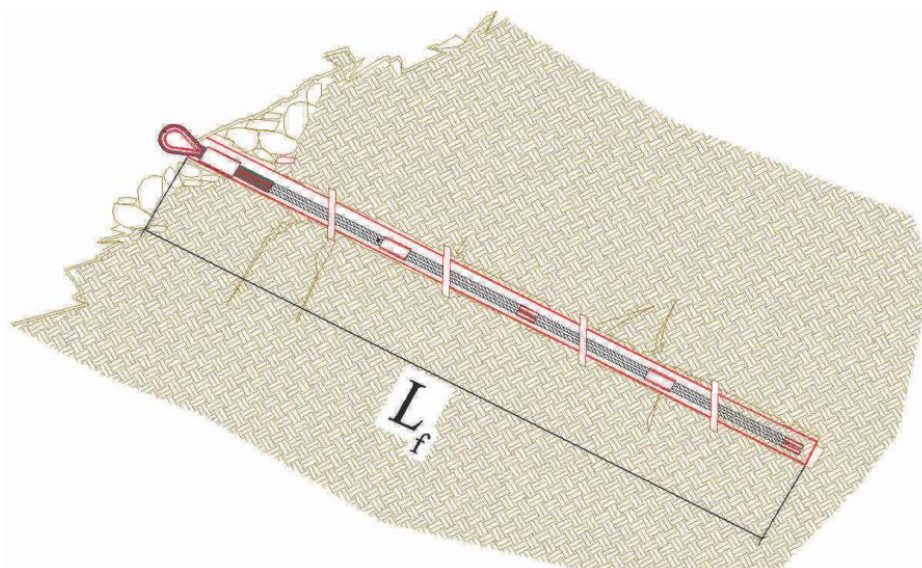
Schema di dettaglio dell'elemento di ancoraggio di fondazione.
